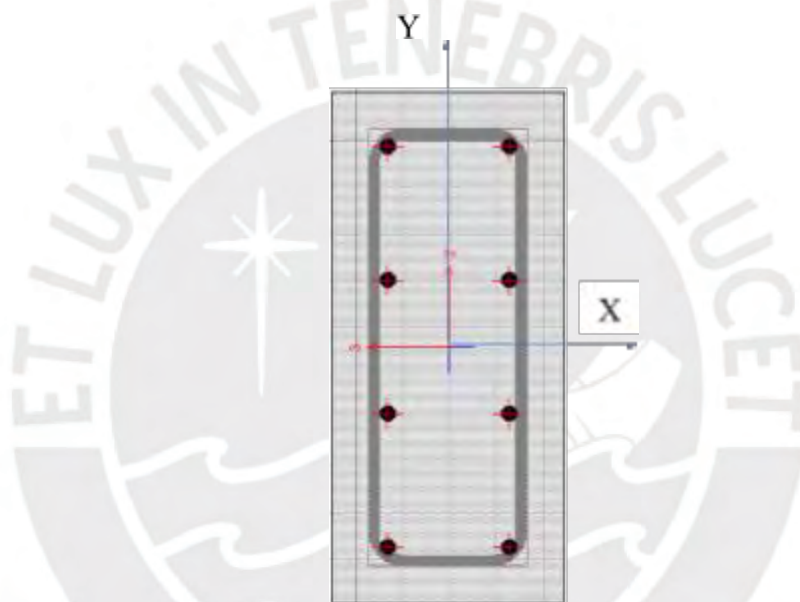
3. Sección de columna C-1 (Fuente - ETABS)
